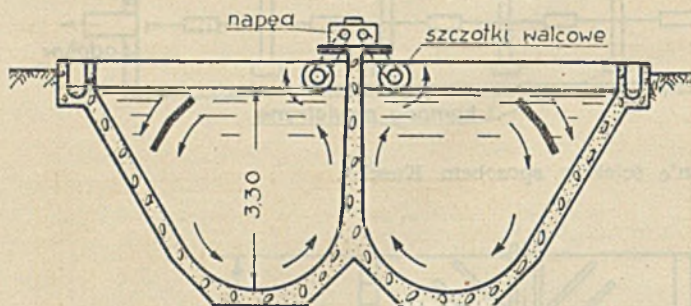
Nawietrzanie ścieków sposobem Erfurckim.
